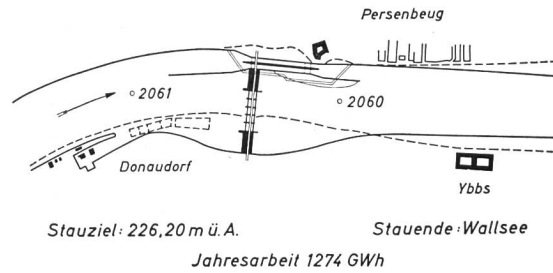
Lageplan Projekt Österreichische Donaukraftwerke AG 1953
